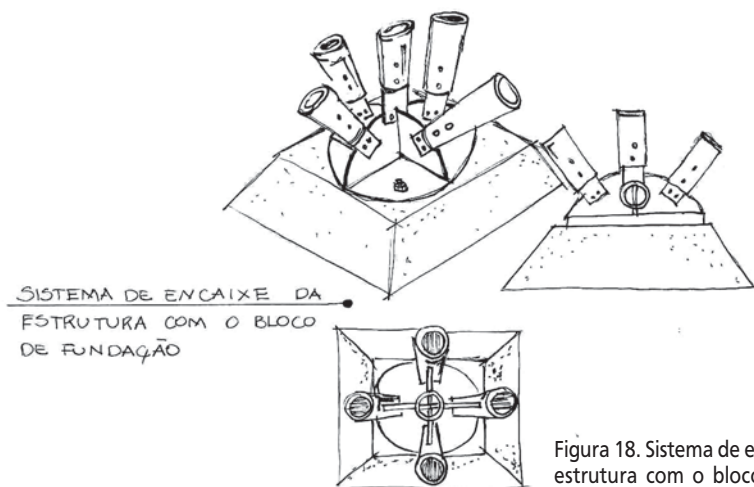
Sistema de encaixe da estrutura com o bloco de fundação (Desenho da autora).
